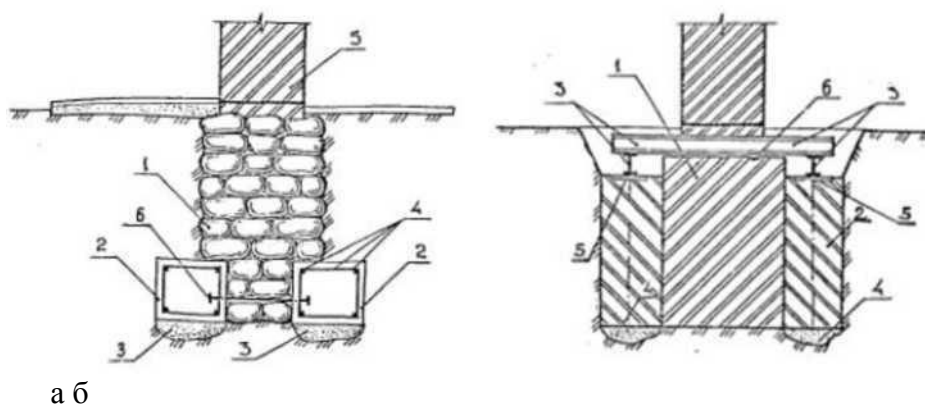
Увеличение опорной площади: а) устройством монолитной железобетонной подушки: 1-усиливаемый фундамент; 2- монолитные приливы из железобетона; 3- уплотненный грунт (втрамбованный щебень); 4- арматура усиления, 5- кирпичная стена; 6- затяжка из арматурной стали; б) устройством дополнительной кирпичной кладки: 1-усиливаемый кирпичный фундамент; 2- дополнительная кирпичная кладка; 3- металлические балки; 4- зоны уплотненного грунта; 5- металлические пластины; 6- отверстие в стене, заполненное цементно-песчаным раствором.
